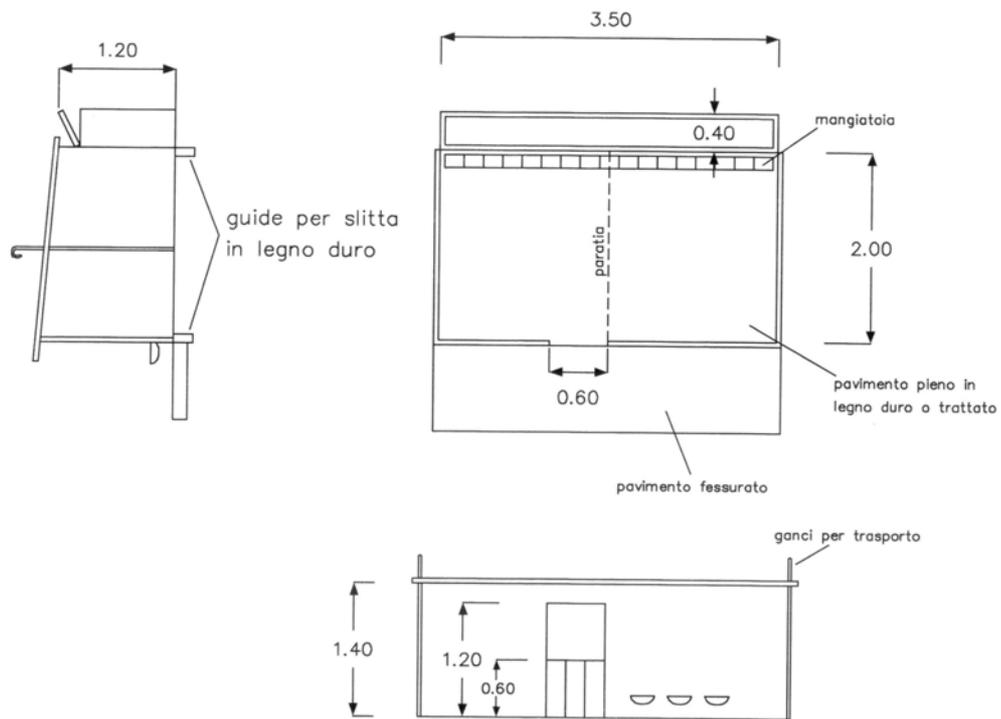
Pianta, sezione e prospetto della capannina per la fase di svezzamento
